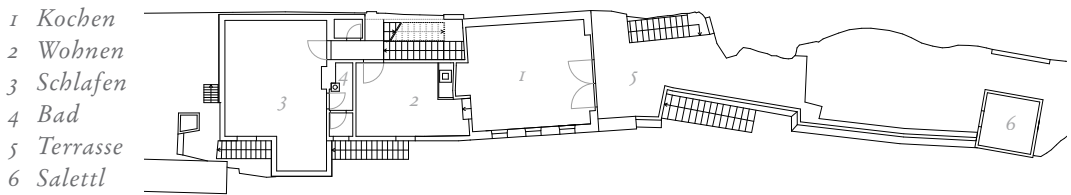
Grundriss Haus Idam-Wimmer
